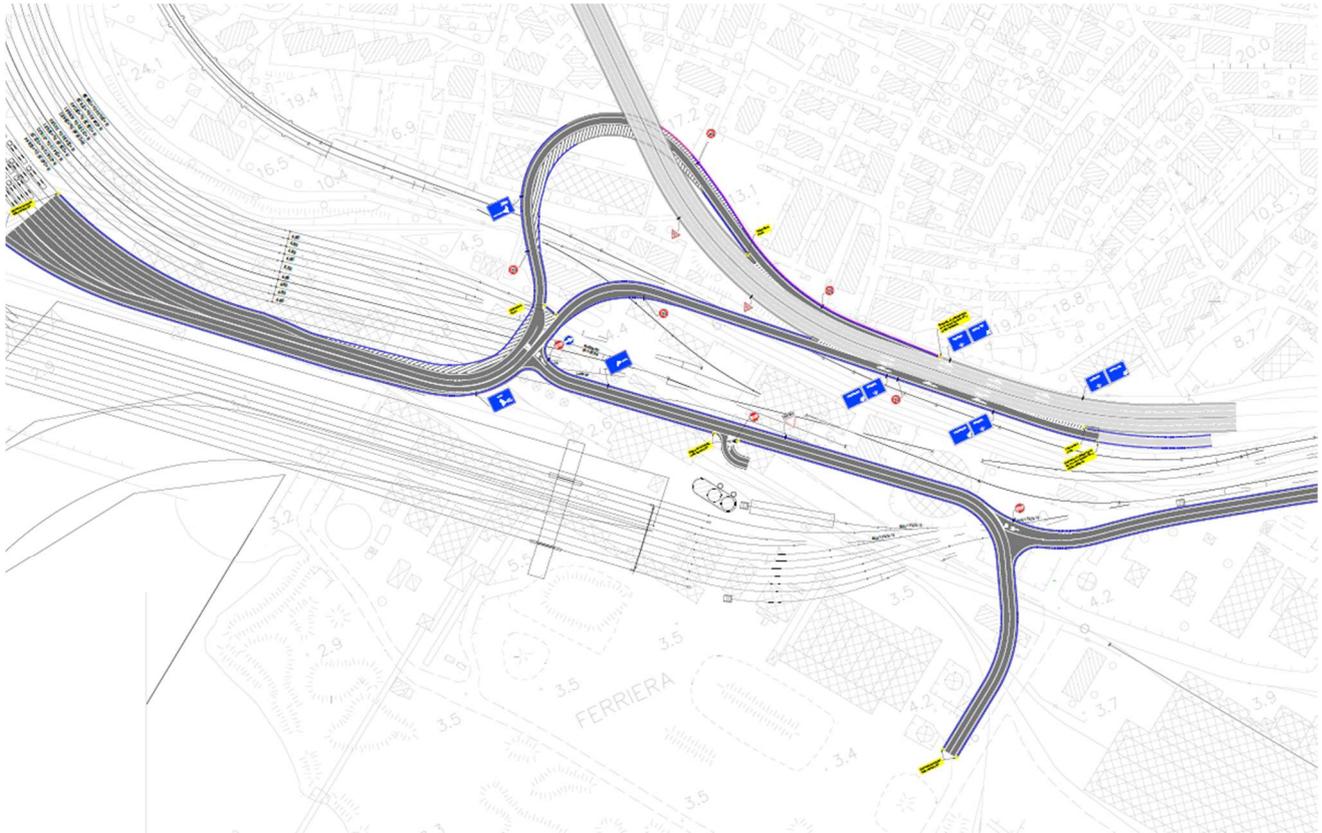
Planimetria del nuovo svincolo stradale di connessione alla GVT (Grande Viabilità Triestina)
